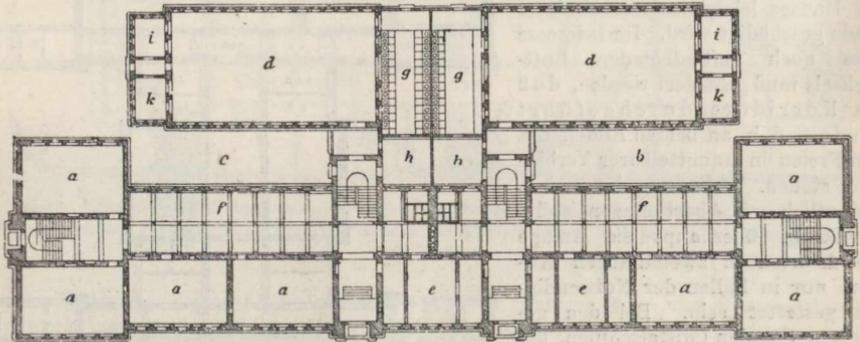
Grundriß vom Erdgeschoß einer Volksschule in Frankfurt a. M.-Sachsenhausen (s. S. 646).
